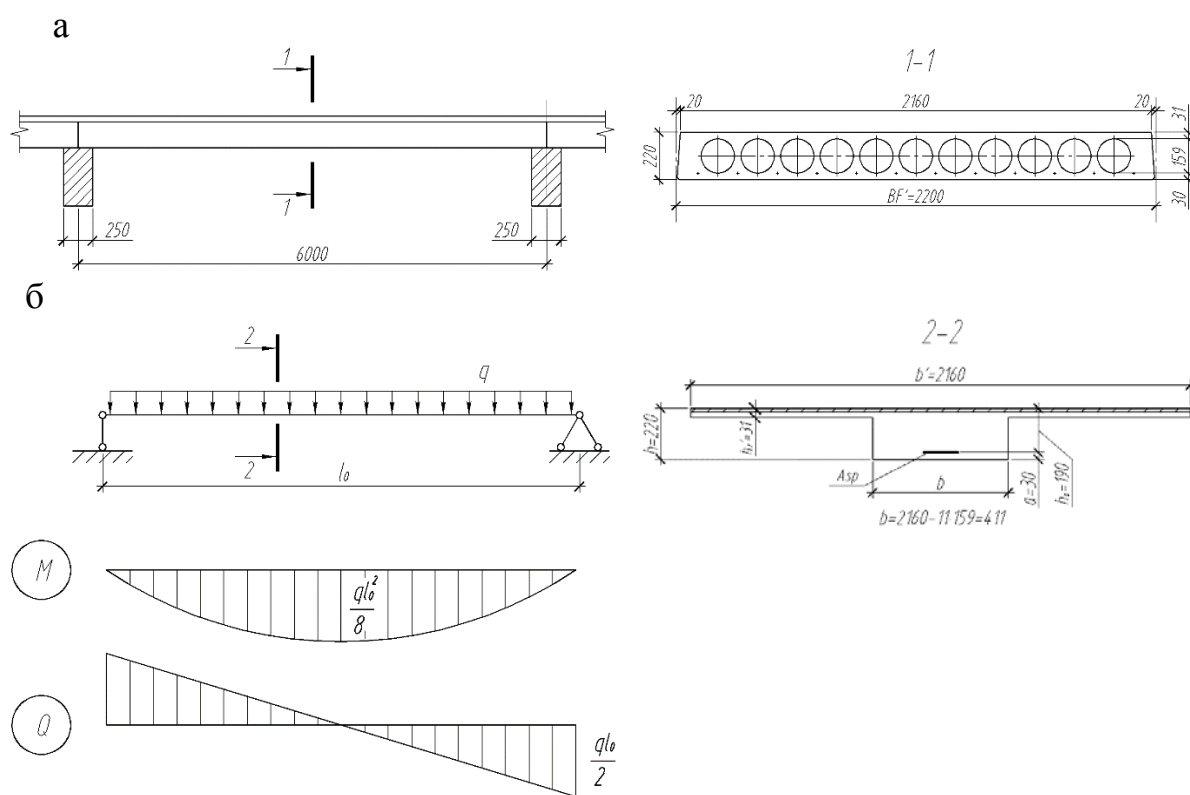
Геометрические размеры (а) и расчётная схема (б) плиты
